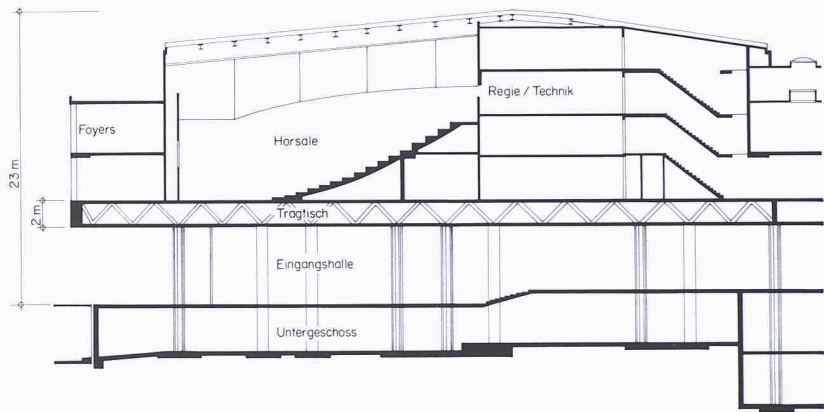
Schematischer Schnitt durch das ursprüngliche Gebäude: Die Obergeschosse werden durch den Tragtisch abgefangen
